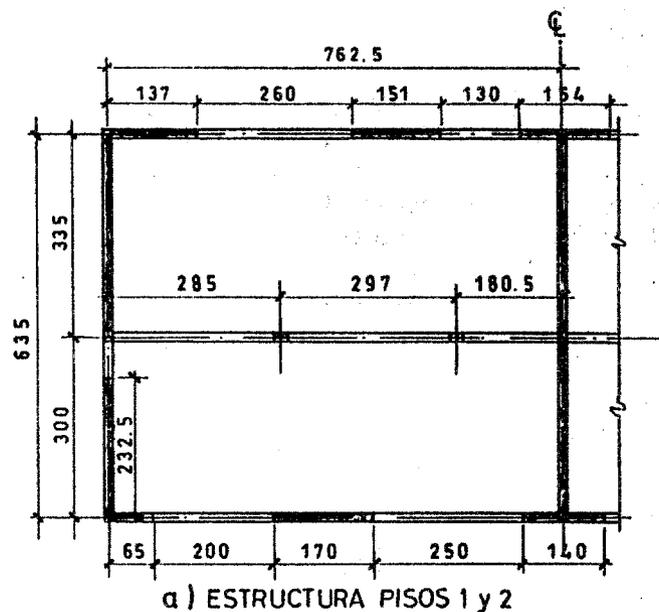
Planta de estructura de un edificio de 4 pisos de altura, con aisladores sísmicos en la base (sobre las fundaciones).
